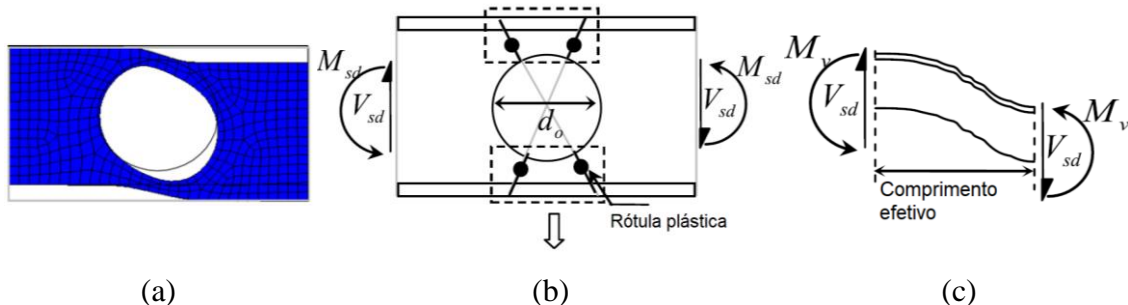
Mecanismo de Vierendeel em uma viga alveolar. (a) Colapso de Vierendeel. (b) Rótulas plásticas. (c) Flexão de Vierendeel e comprimento efetivo.
